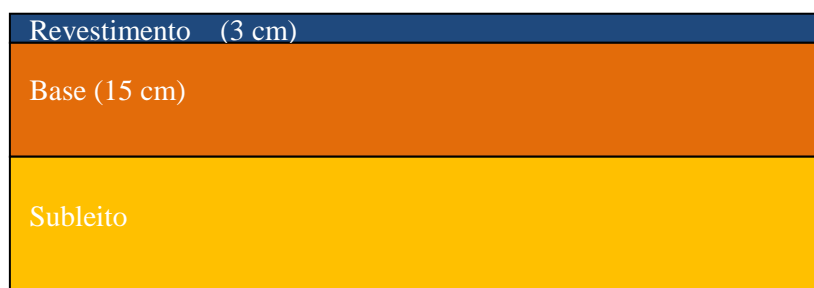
Croqui esquemático da estrutura do pavimento
